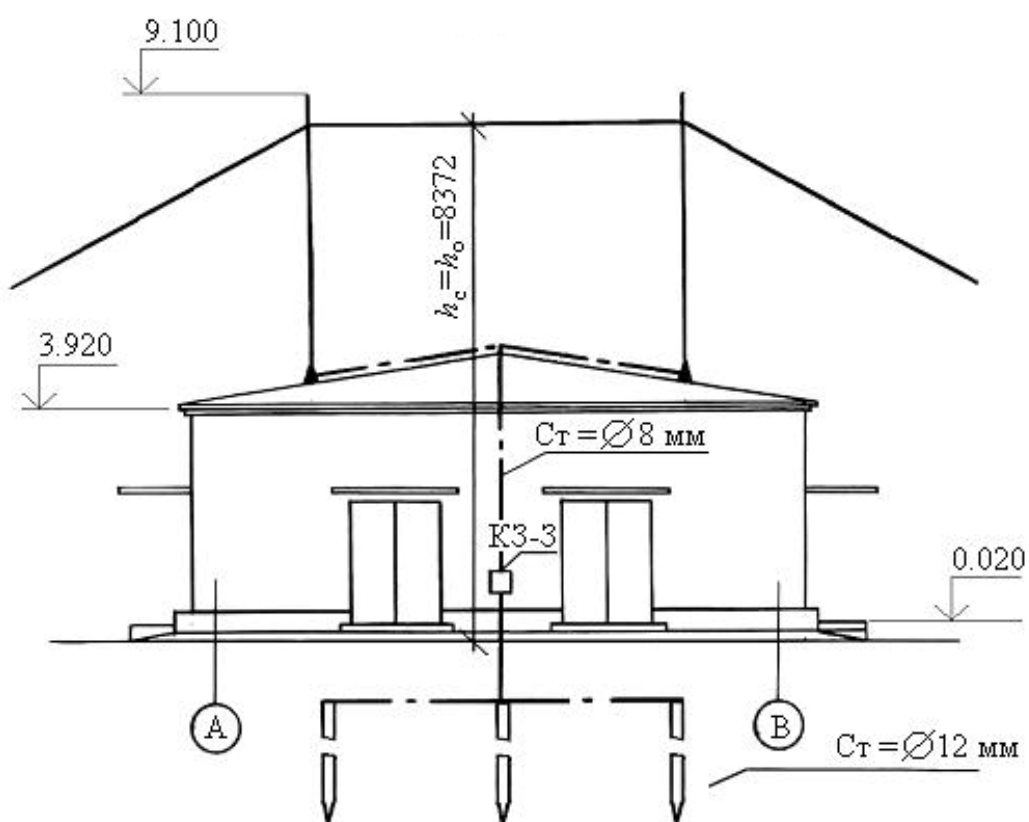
Молниезащита здания насосной (фасад по оси 1)
